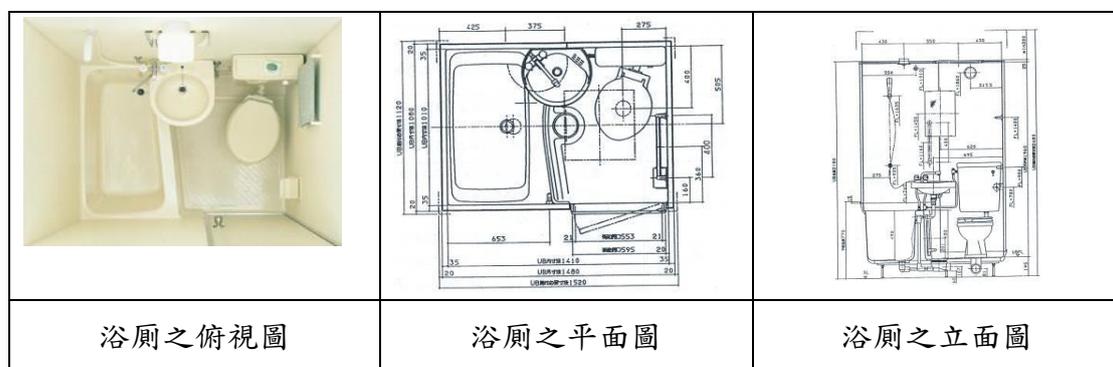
浴廁空間配置之俯視圖、平面圖及立面圖
